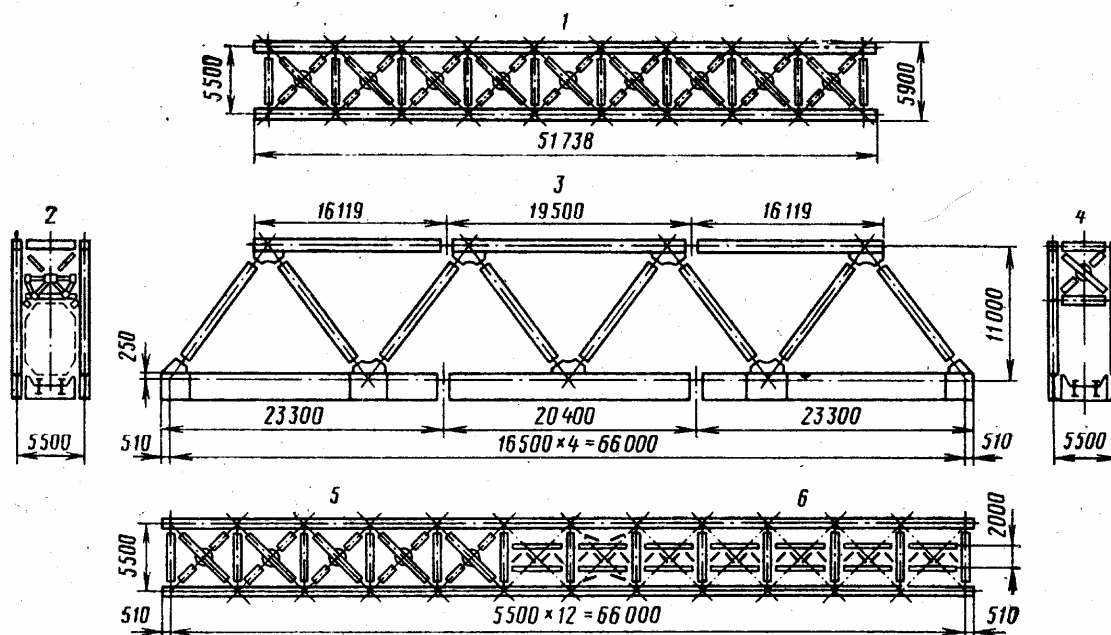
Схема пролетного строения с фермами с жестким нижним поясом
